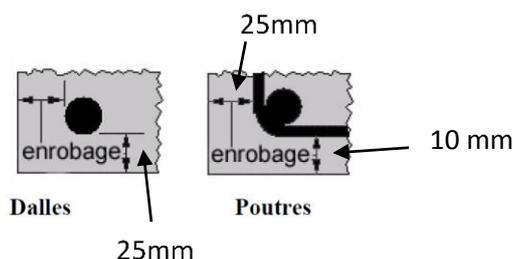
Enrobage des armatures dans les poutres et les dalles
